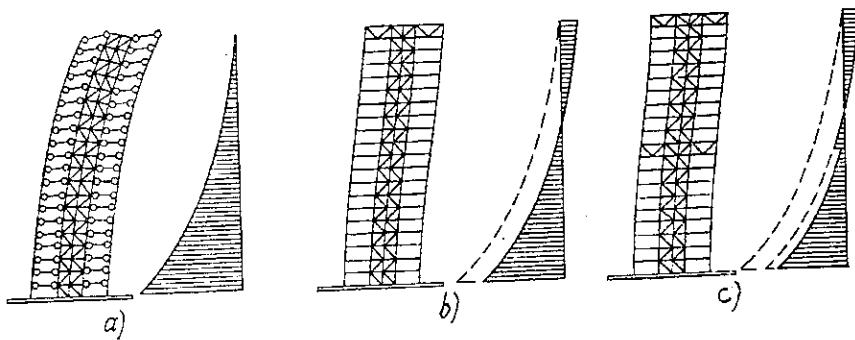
Biểu đồ ứng suất khi có các liên kết khác nhau
